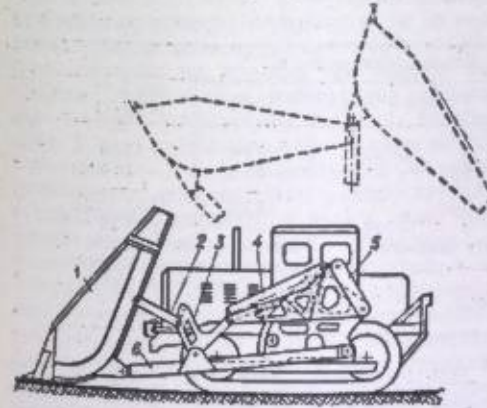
Одноковшовый погрузчик Т-157 с задней разгрузкой: 1 — ковш; 2, 3 — промежуточные рычаги; 4 — гидроцилиндр для подъема стрелы с ковшом; 5 — промежуточный кудиса; 6 — стрела.
